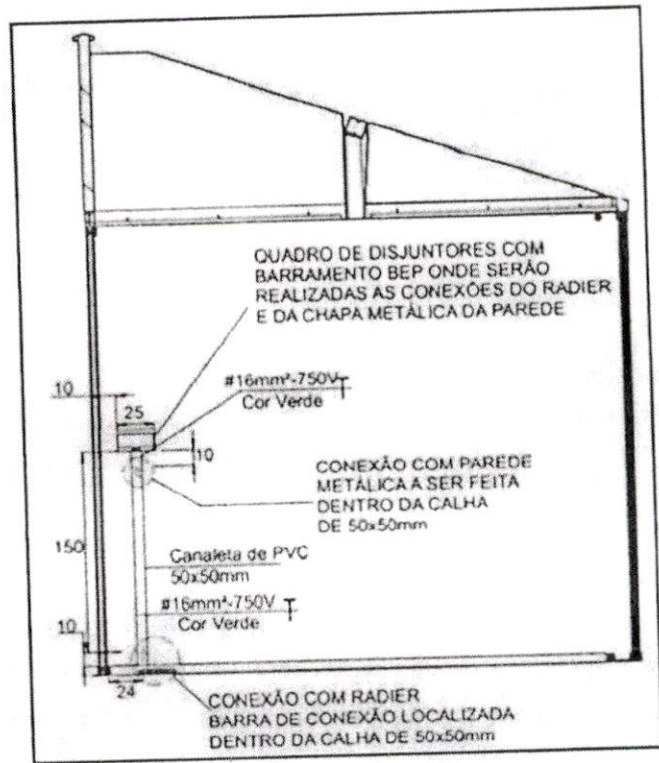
Conexão Barramento BEP x Radier x Chapa Metálica do Painel
